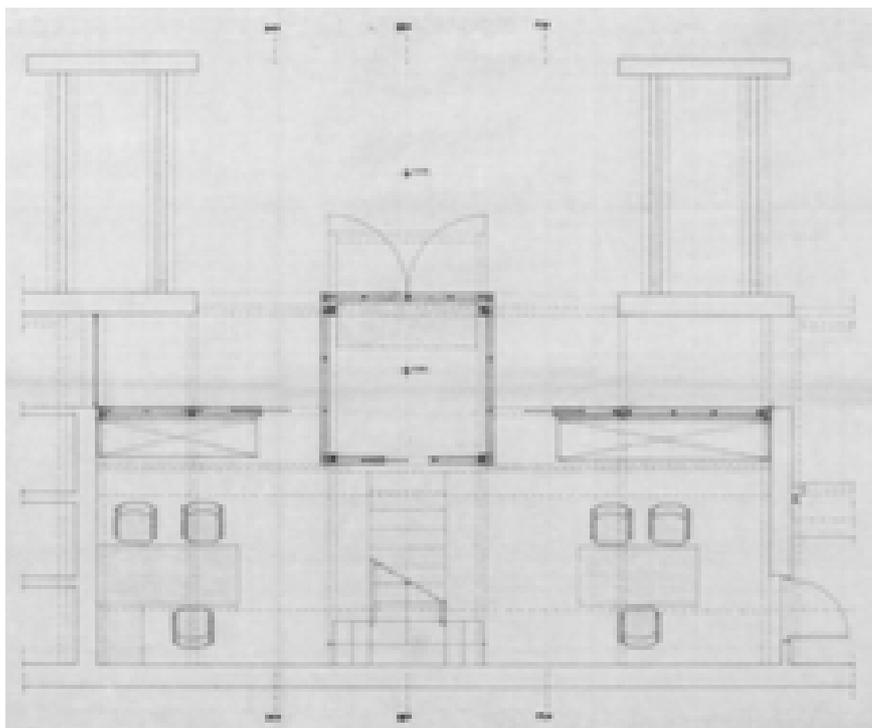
Pianta regia piano sala, opere di completamento – 22/04/1997 (AABS-500)
